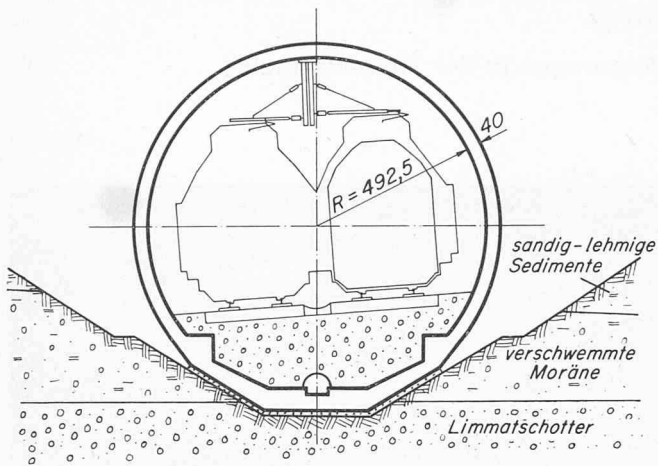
Das gewählte Tunnelprofil für die Tagbaustrecke des Heitersbergtunnels
